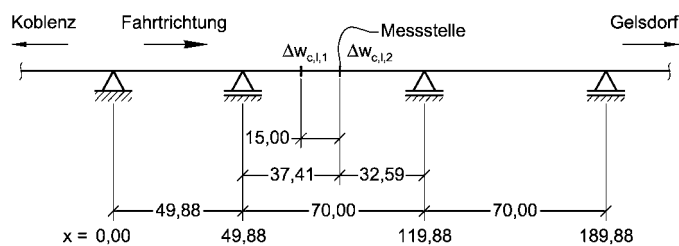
Statisches System (Auszug) und Instrumentierung
